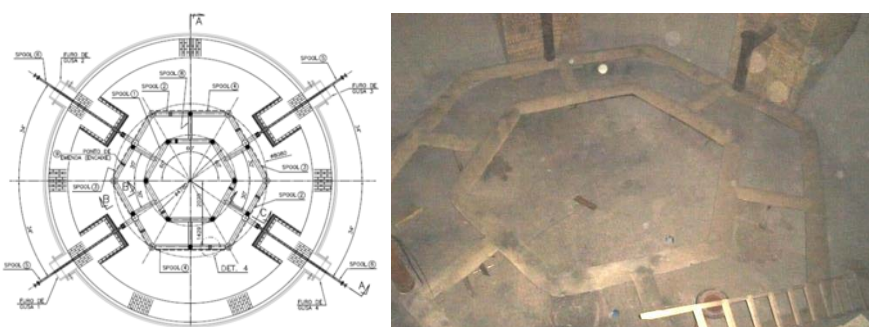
Dispositivo instalado para secagem do cadinho e furos de gusa do AF3.
